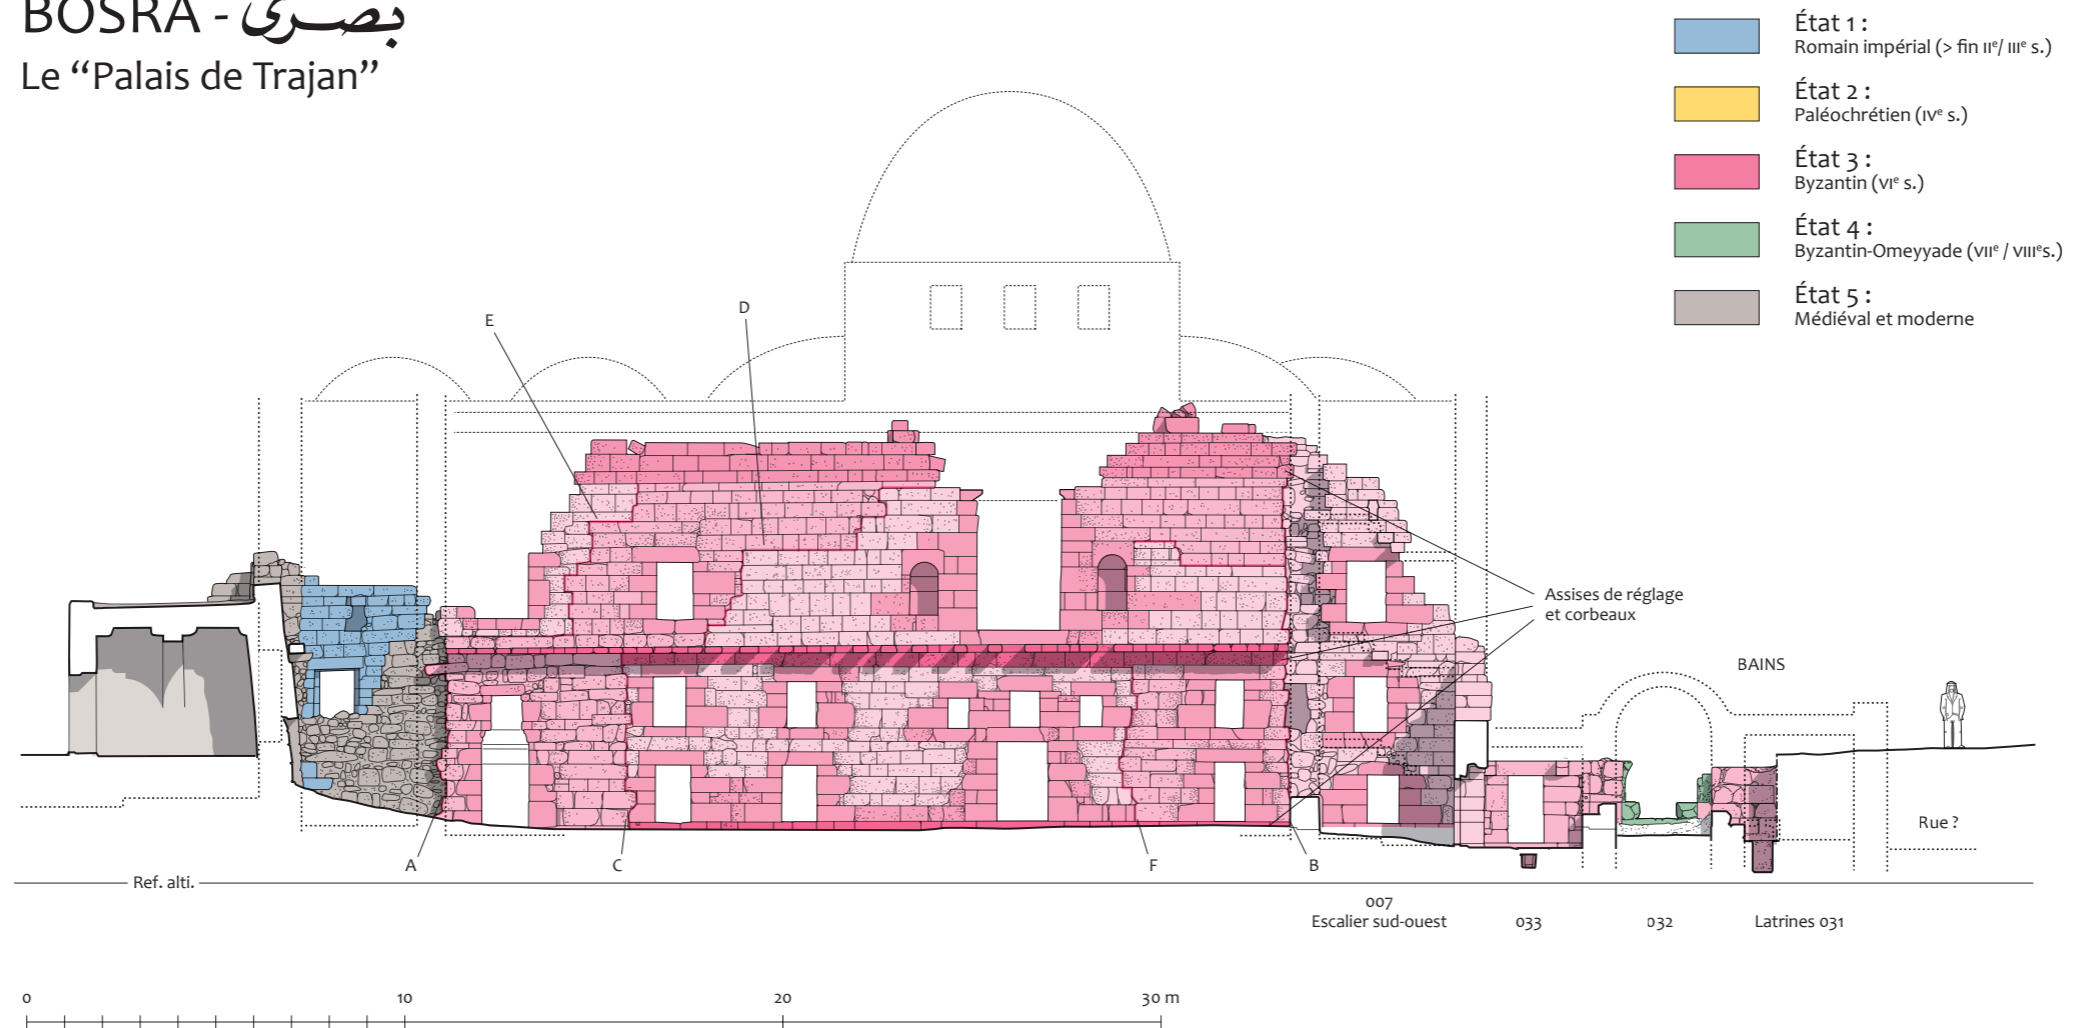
Le « Palais de Trajan », coupe 1, façade sud (sur cour).
